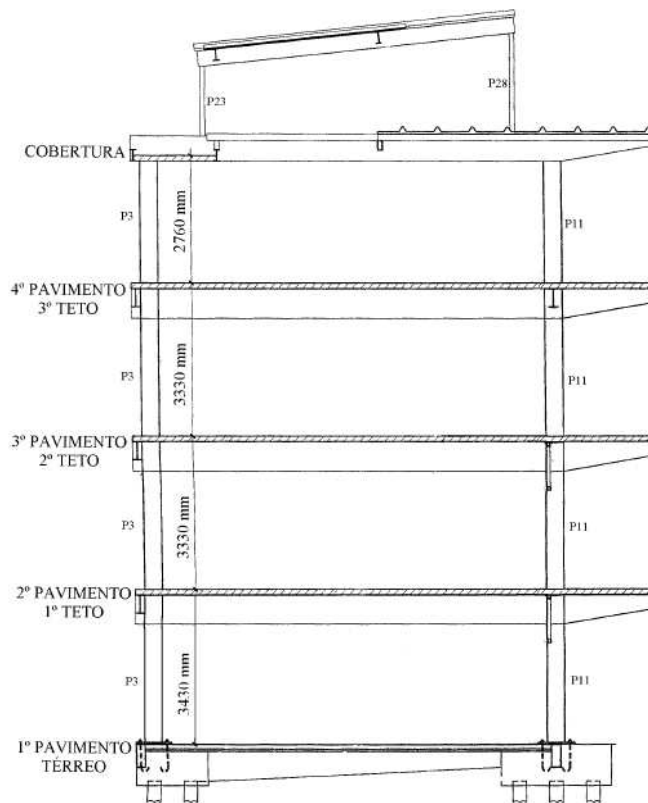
Estrutura do pavimento tipo do edifício – Corte AA (Battista e Varela, 2002).
